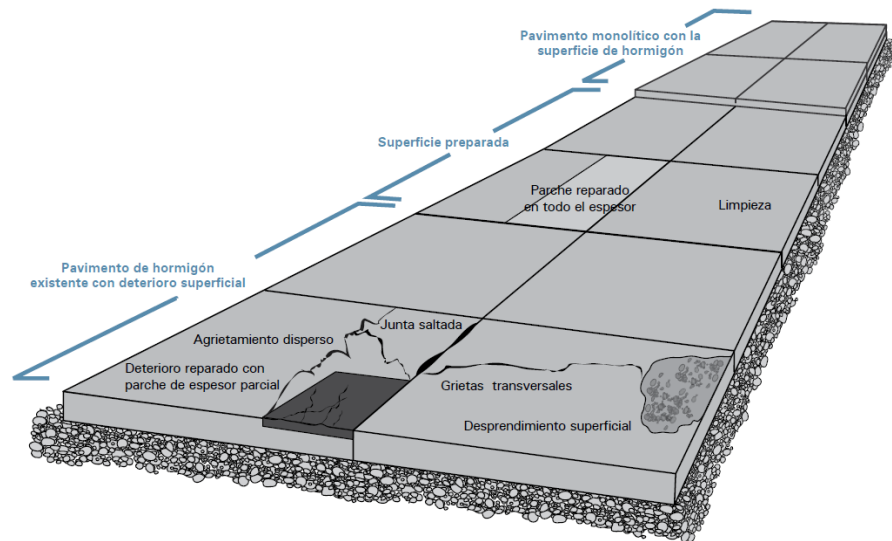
Whitetopping adherido a pavimentos rígidos en buena condición con deterioro superficial
